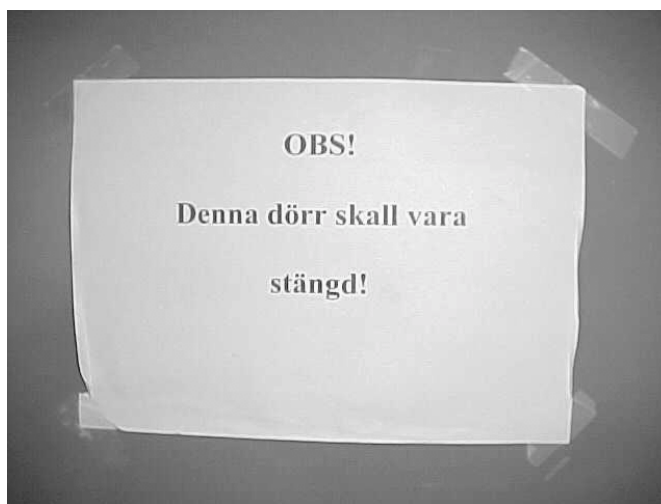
och 3.4. Uppställd branddörr till arkiv på plan 5 i B-byggnaden.
